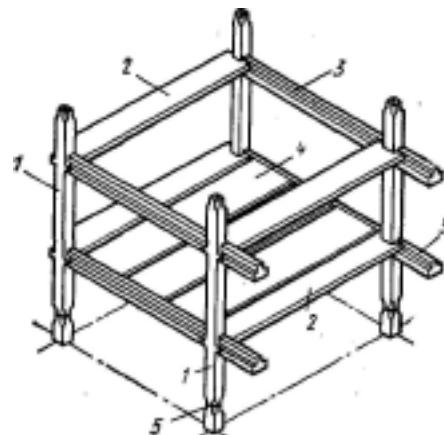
Сборный железобетонный унифицированный каркас:
